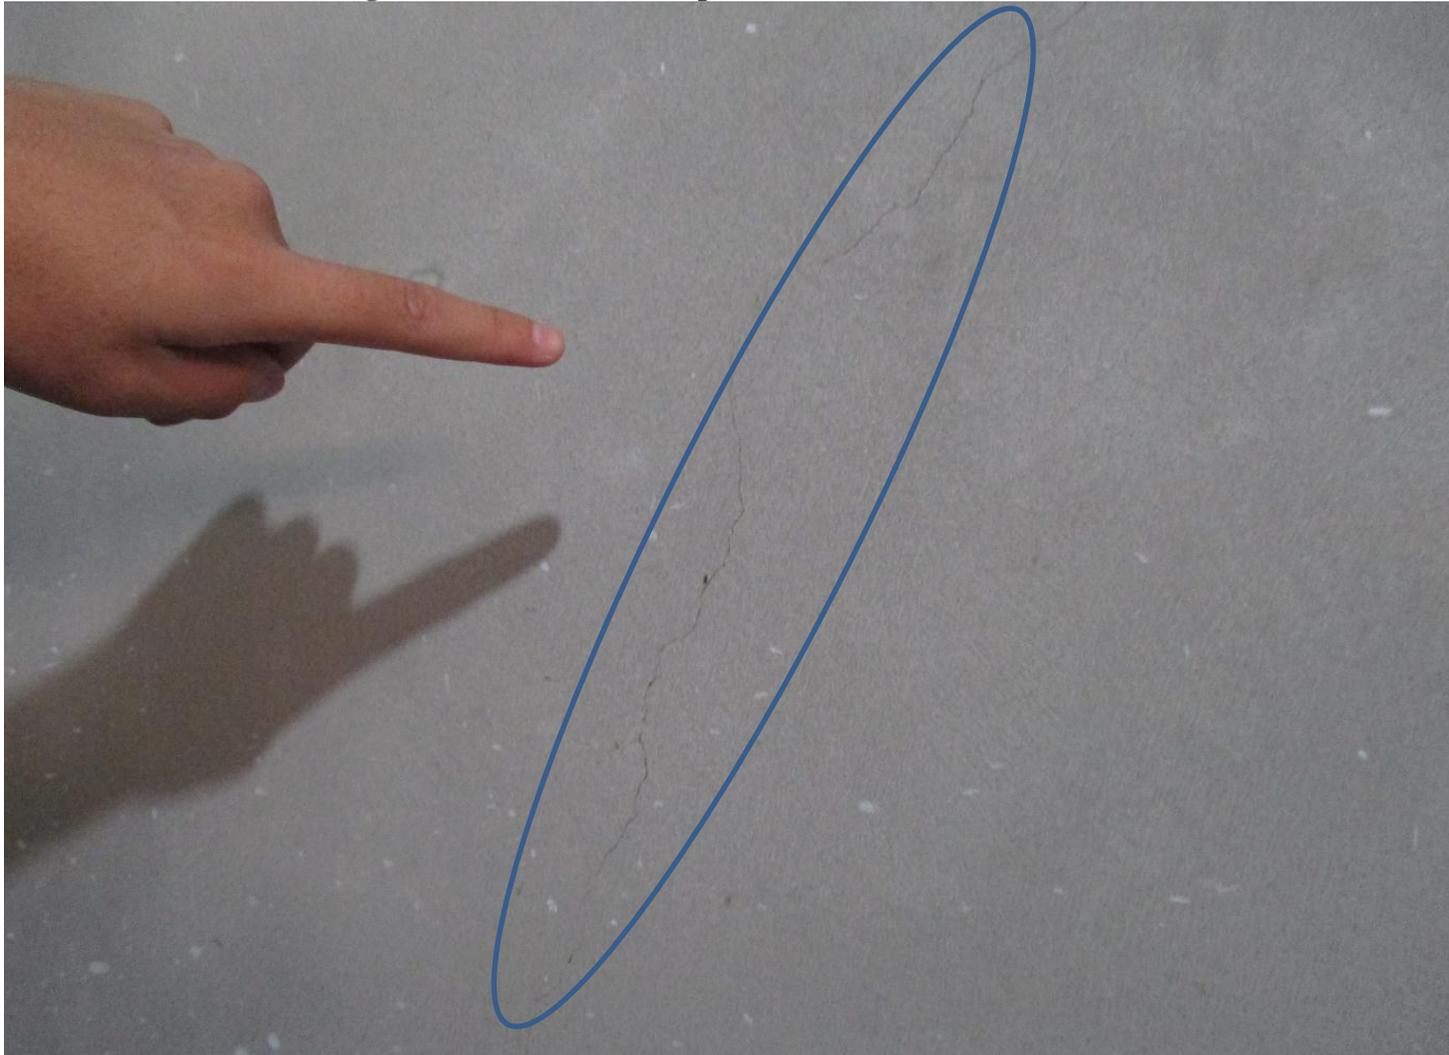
Columna afectada por fisura en Unidad Muestral 6.
